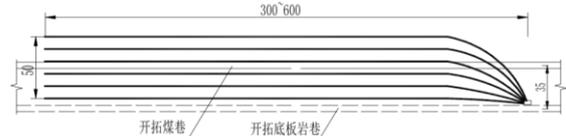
开拓底板岩巷千米定向钻孔平面布置示意图(单位:m)
